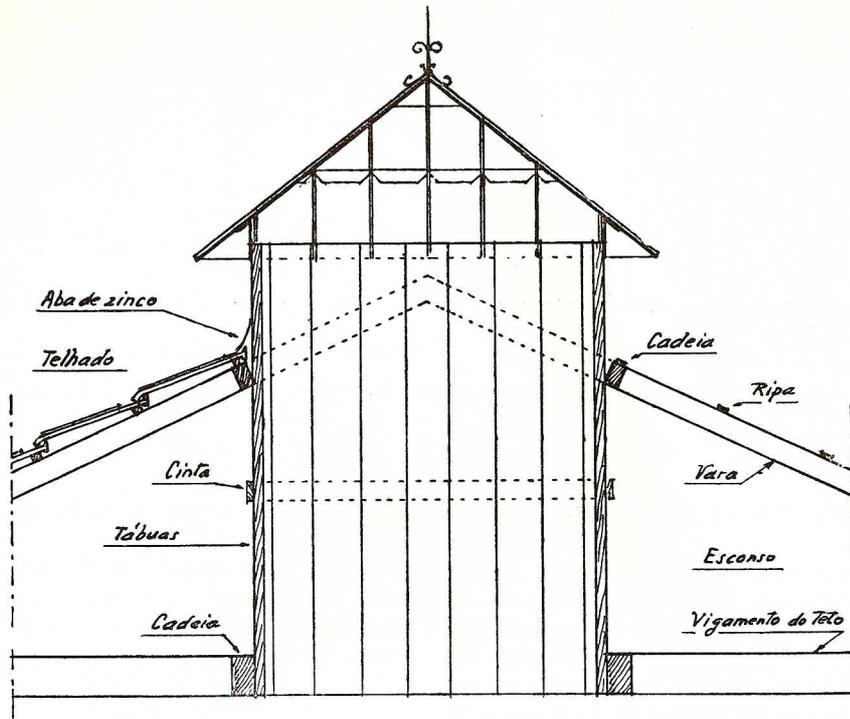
CORTE DE CLARABÓIA DE PLANTA QUADRADA
